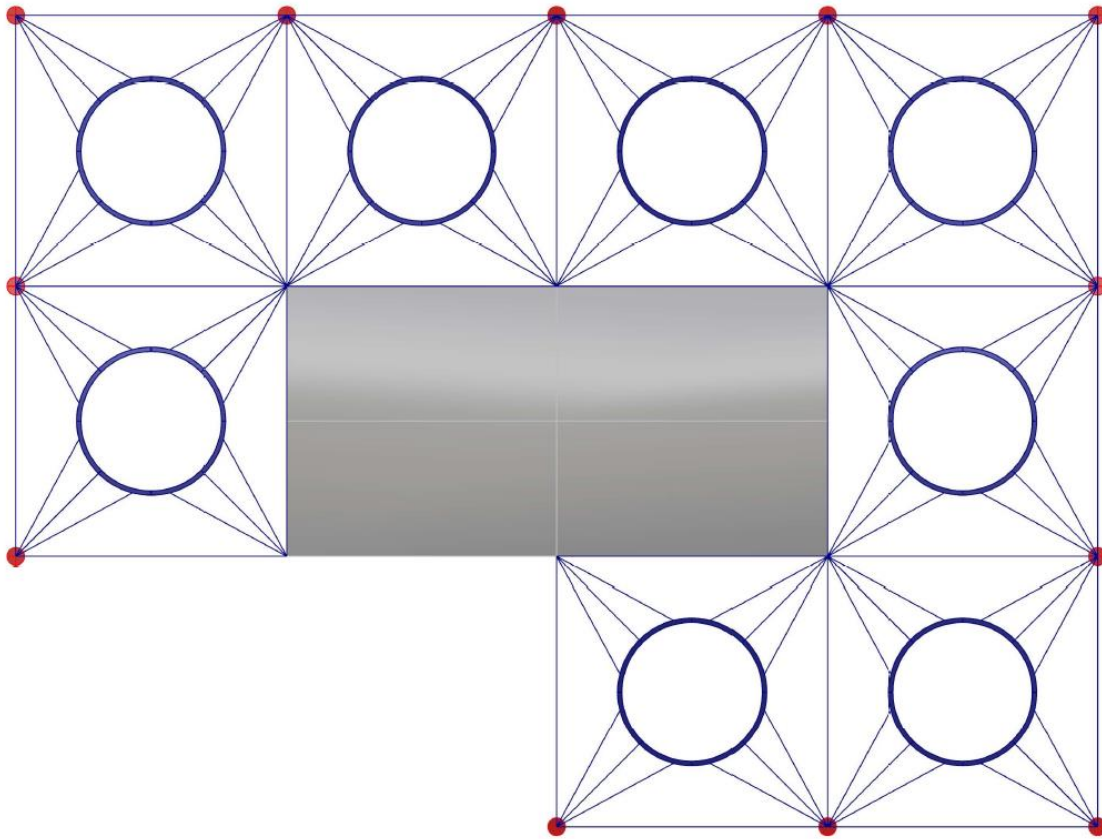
Detalle retícula. Fuente: Elaboración propia
